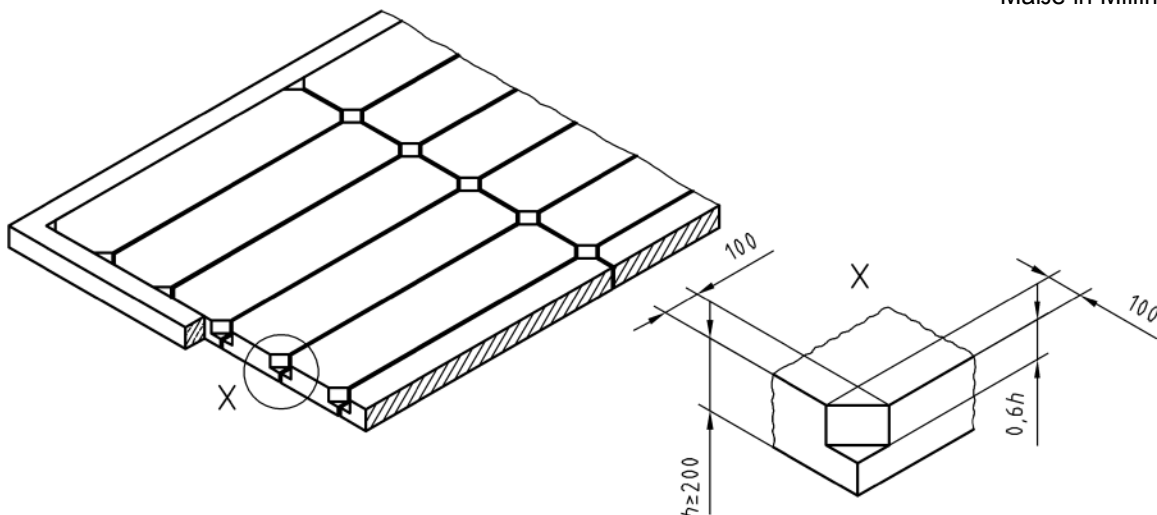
Ausbildung einer Scheibe mit Fugenbewehrung, Betoneckdübeln und umlaufendem Stahlbetonringanker
